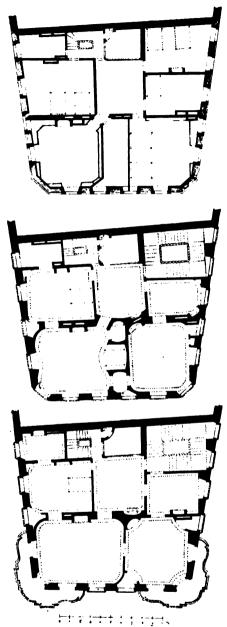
Haus Bréthous zu Paris. Grundrisse des Dachgeschosses und der beiden Hauptgeschosse.
